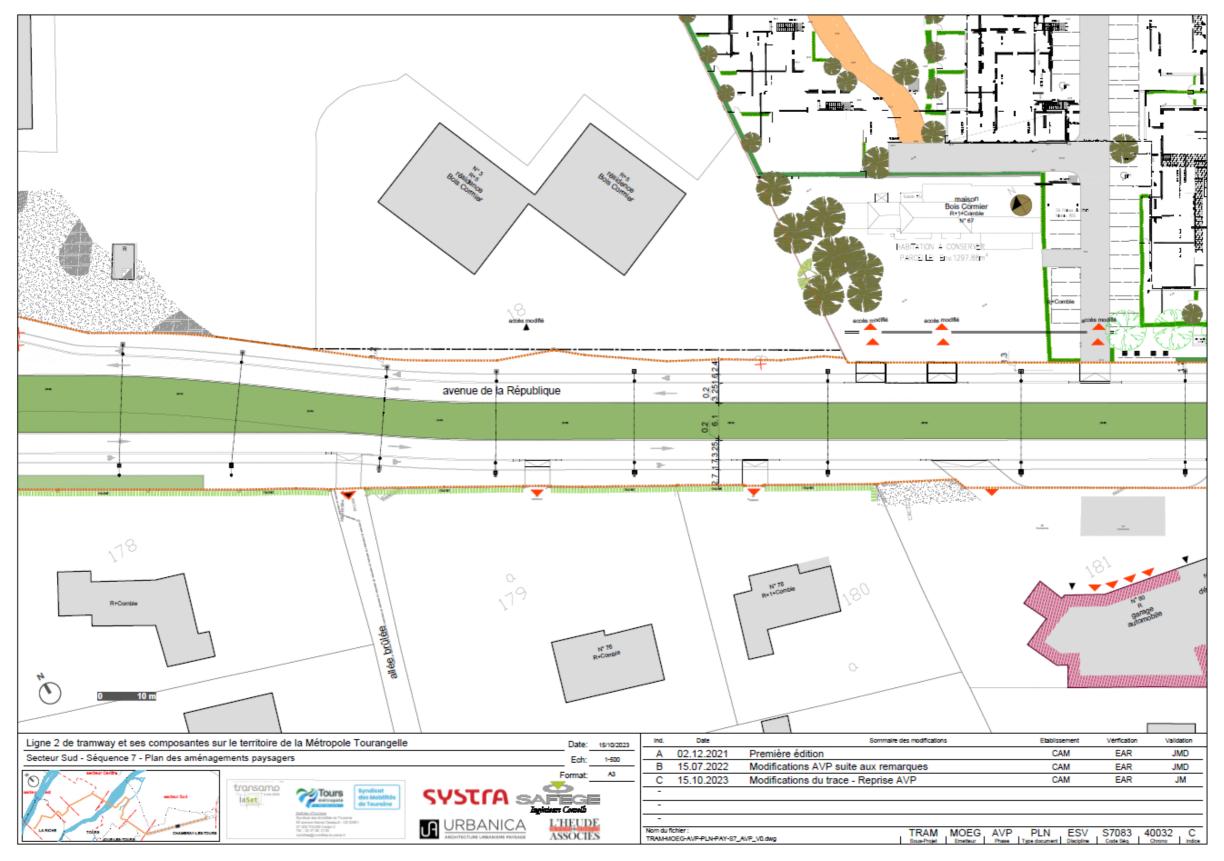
plan masse de localisation des arbres à abattre sur avenue de la République – Section 3 (planche 11)
